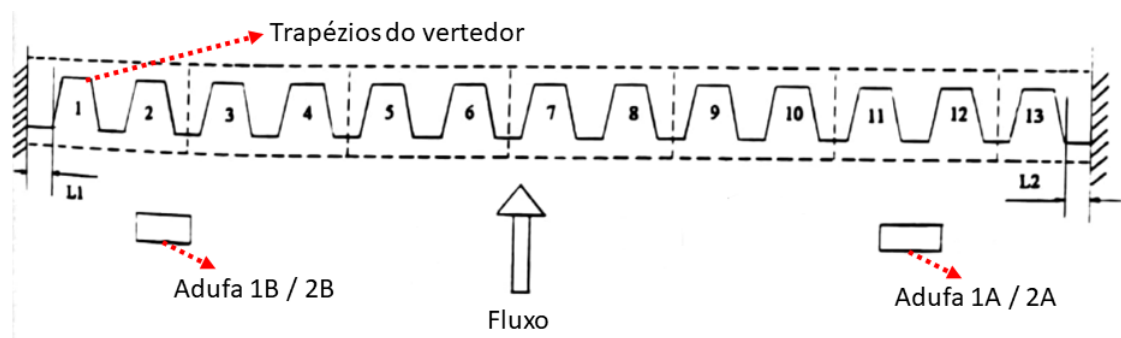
Desenho esquemático em planta da região das adufas e dos vertedores.
